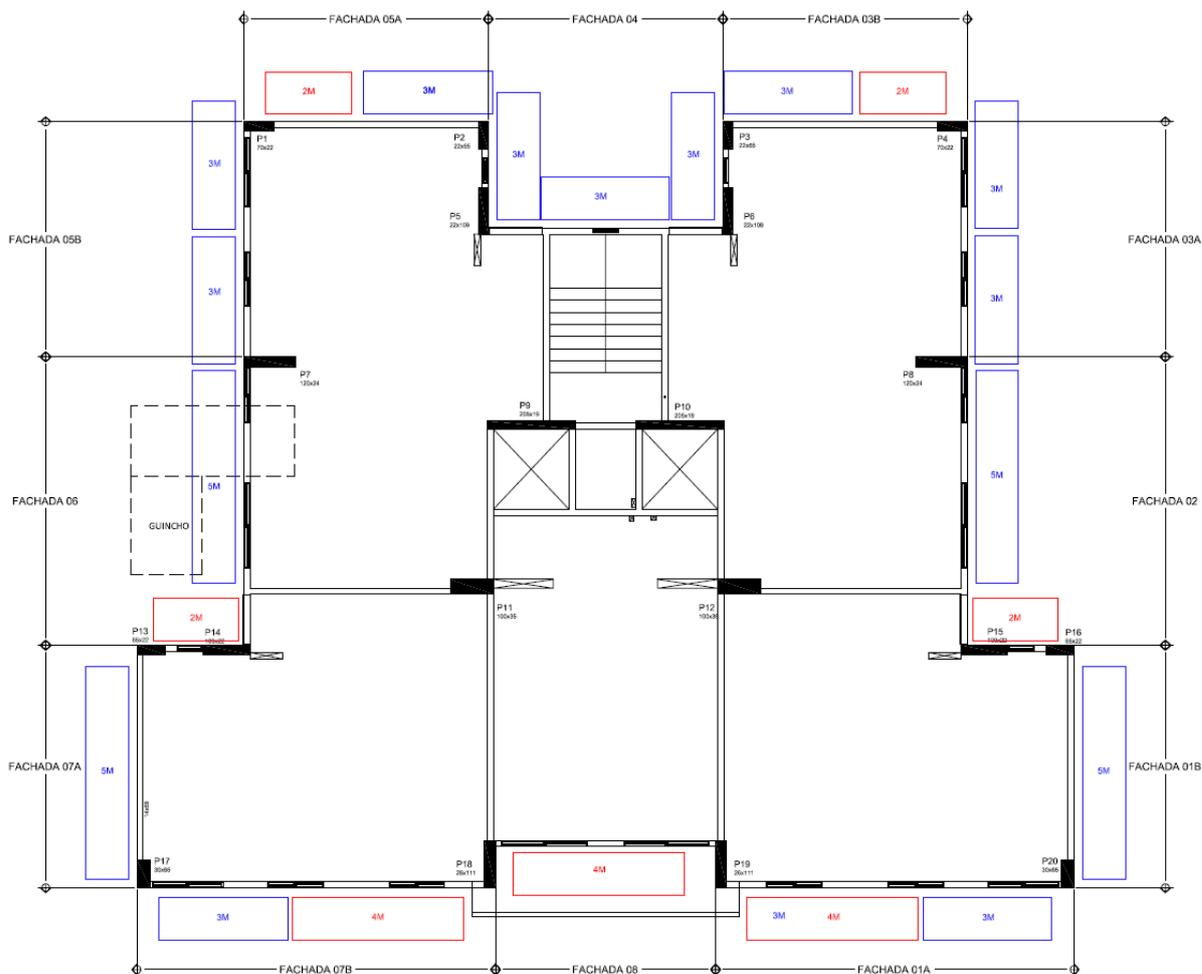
Definição do Tamanho do Lote de Produção e Transferência – Fachadas (Autor, 2014)
